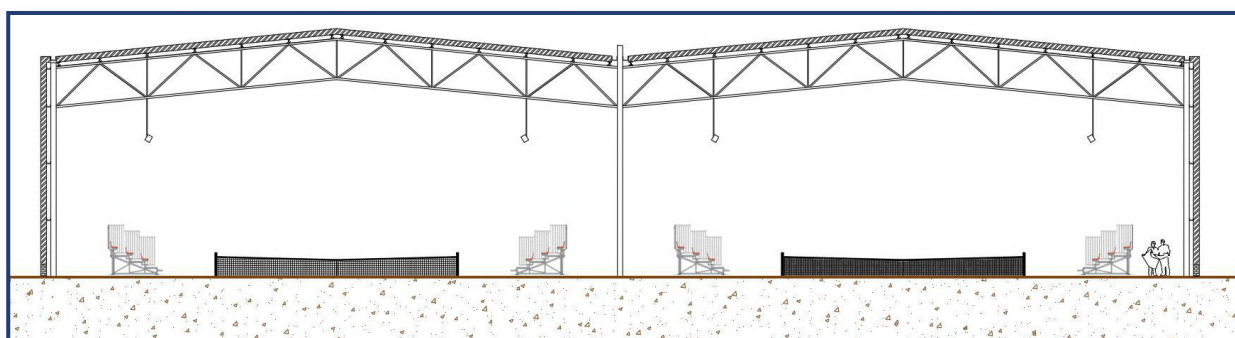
Sección tipo de la estructura y cerramiento de las naves adosadas.
